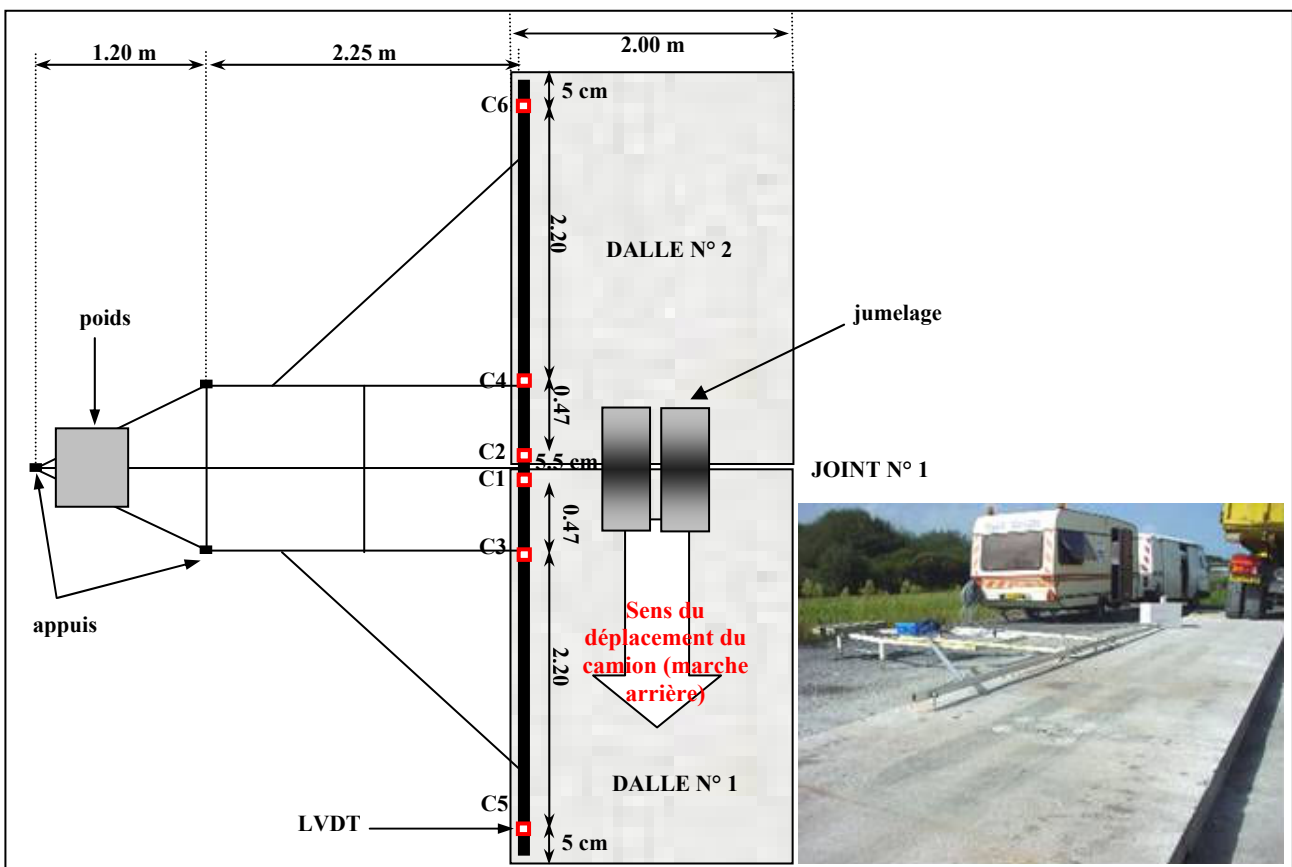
Dispositif de mesure du battement et des déflexions en bord de dalle.
